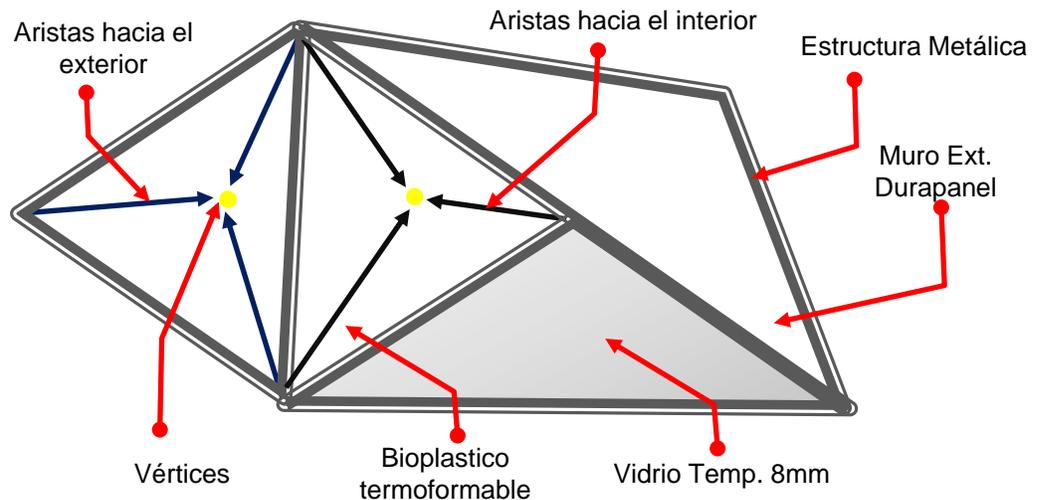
Esquema de fachadas. Fuente: Elaboración Propia
